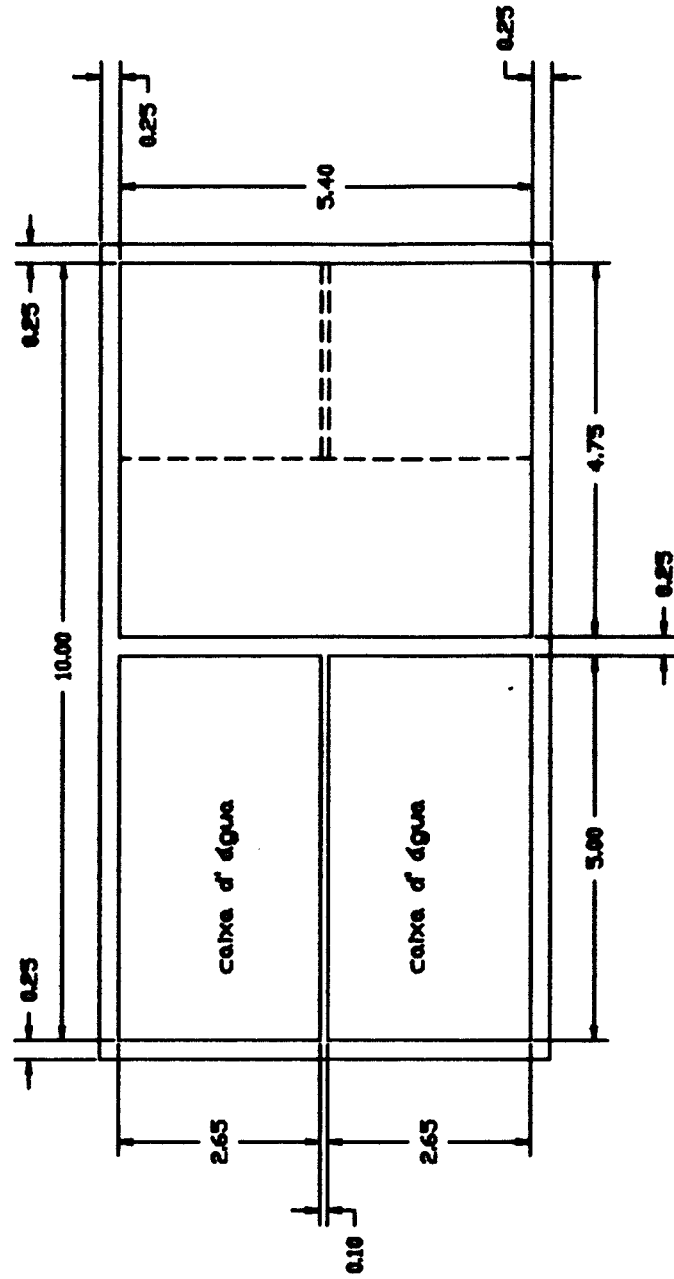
Planta da casa de máquinas e caixa d' água.
